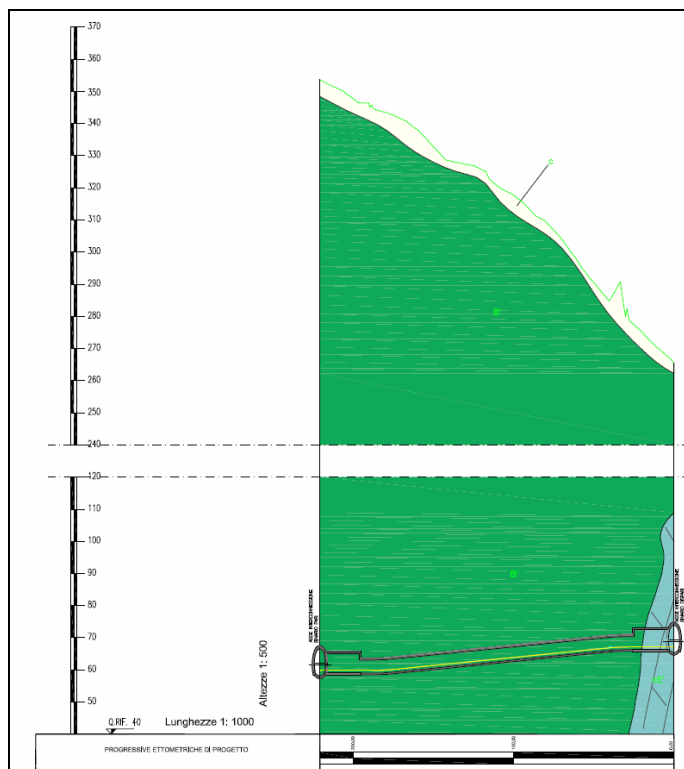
Stralcio profilo geomeccanico del by-pass di collegamento
